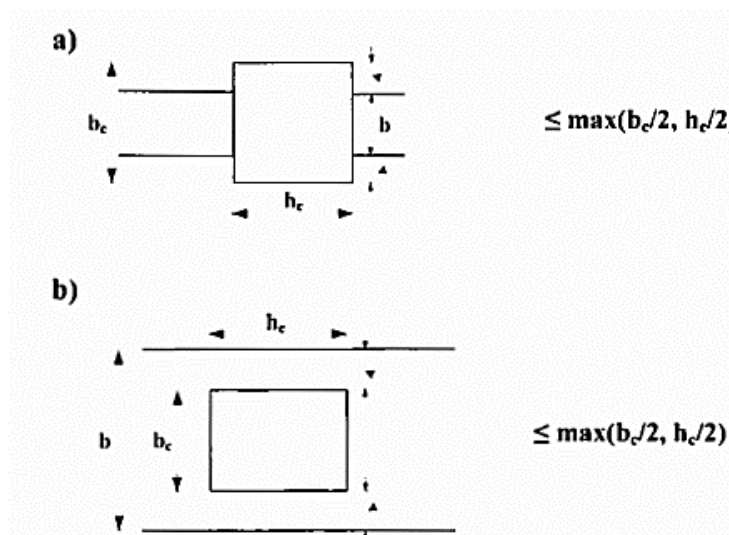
17:Dimension à respecter pour les poutres (RPA2024)
